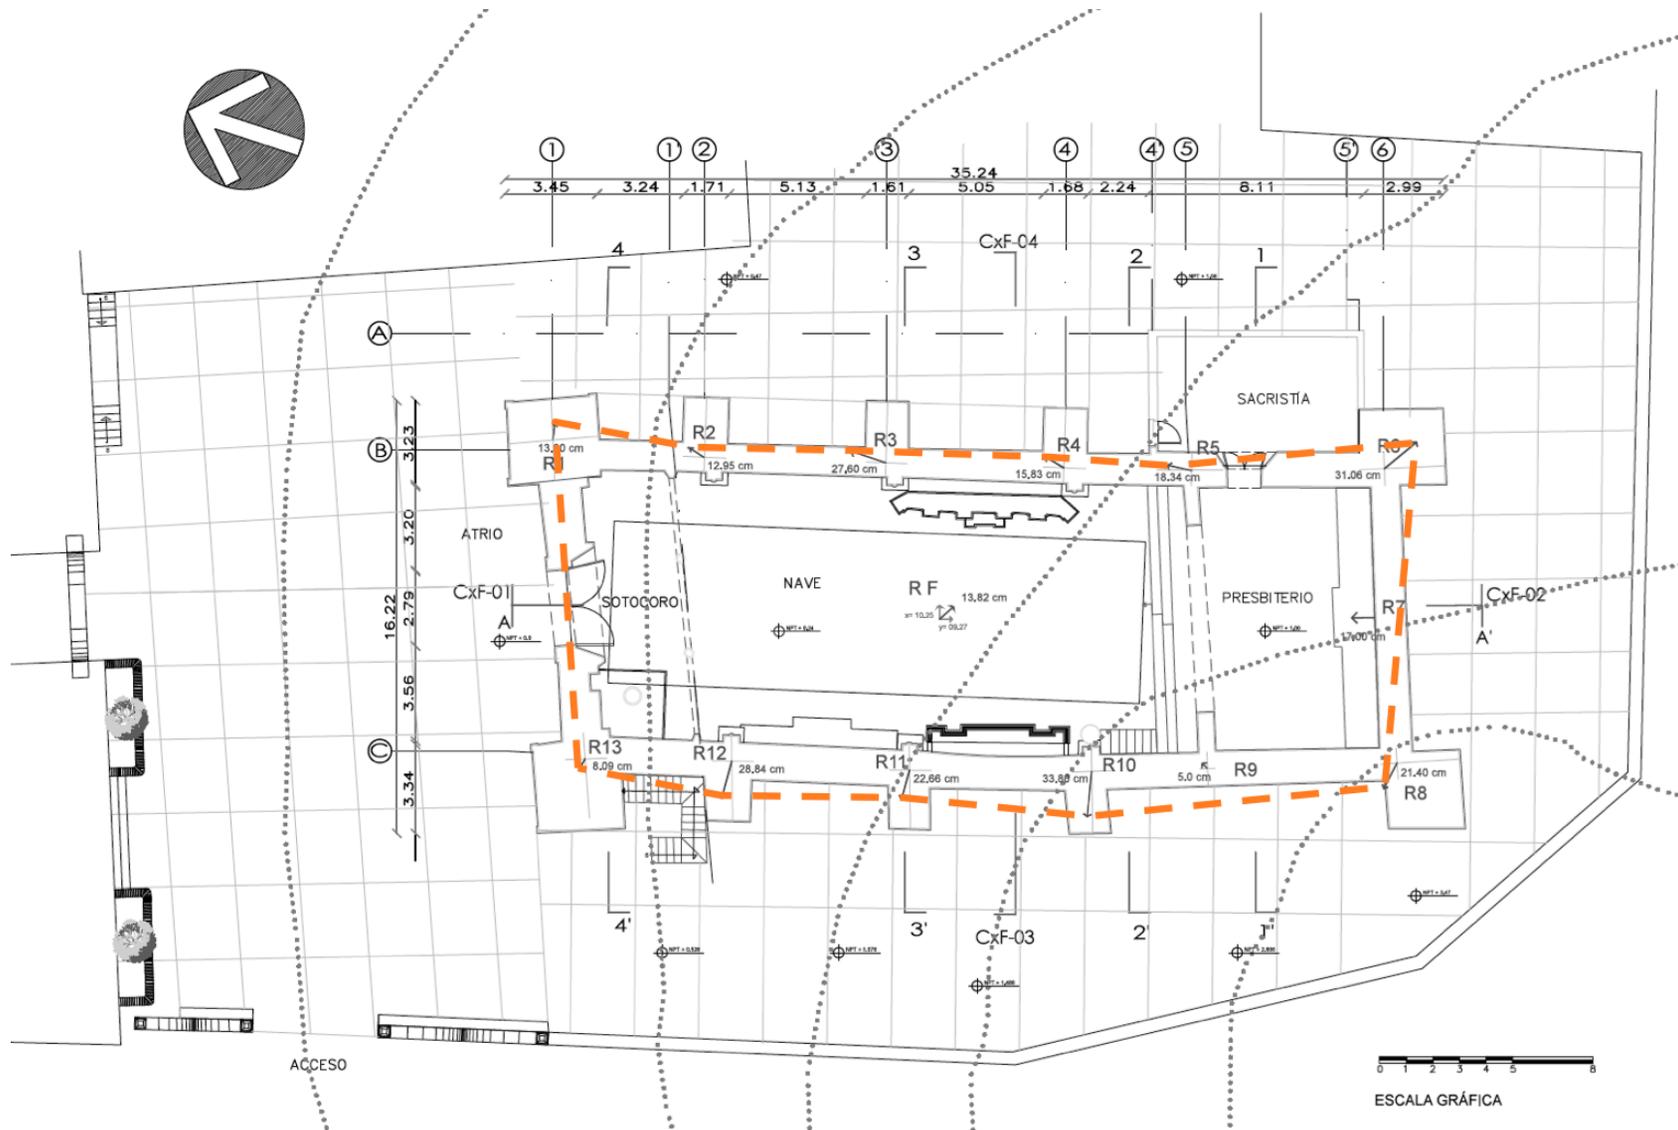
Planta arquitectónica del templo, en dónde la línea naranja señala la deformación que presentan los muros de la nave.
